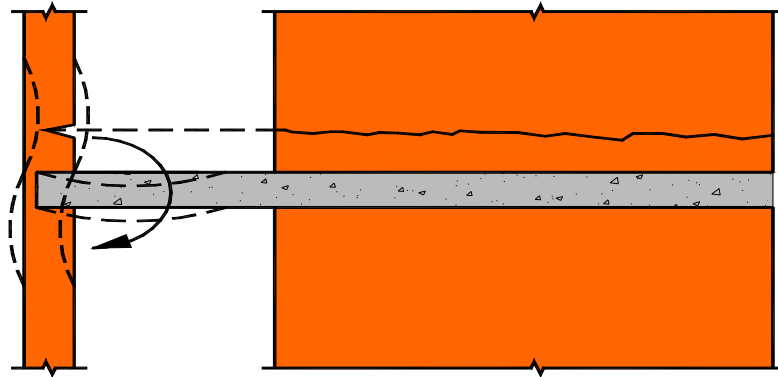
Fissura horizontal na base da parede provocada pela deformação excessiva da laje [30]
